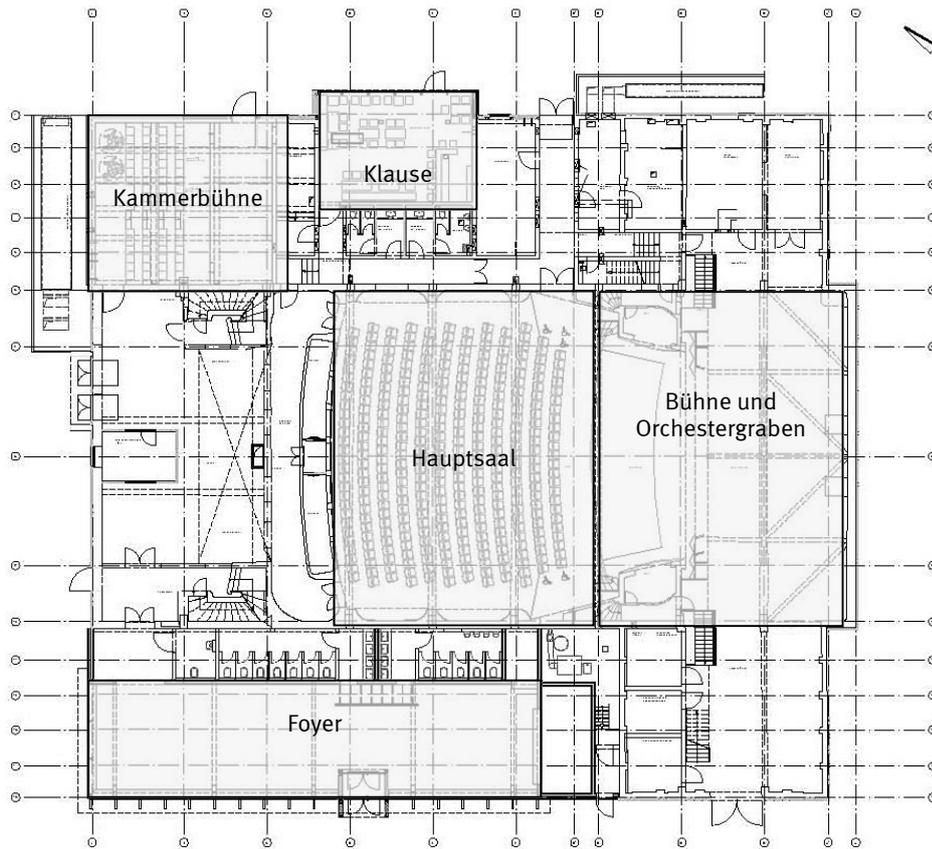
Grundriss Erdgeschoss mit markierten exemplarischen Messräumen, ohne Maßstab
